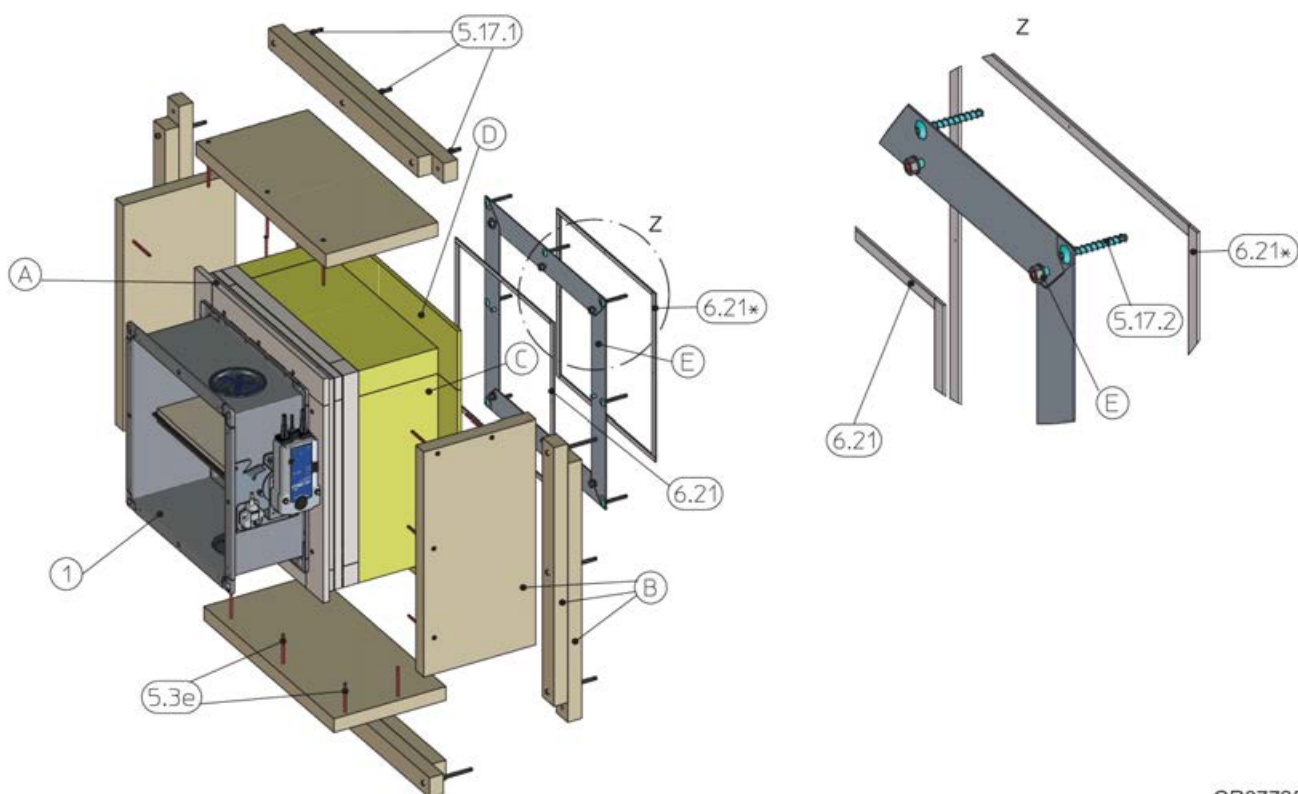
Kit d'installazione WA per installazione a secco – montaggio
